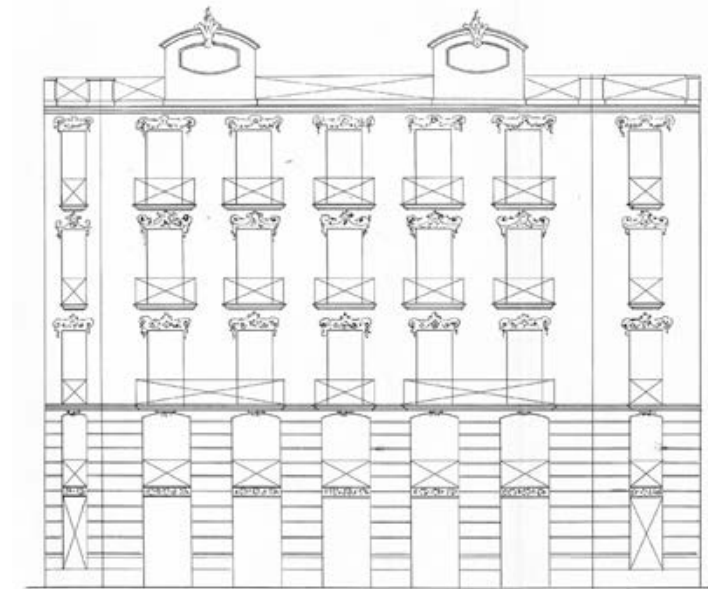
Edificio de 1915 en la calle Sueca nº 30, chaflán con la calle Puerto Rico, compuesto de planta baja con entresuelo, y tres plantas
